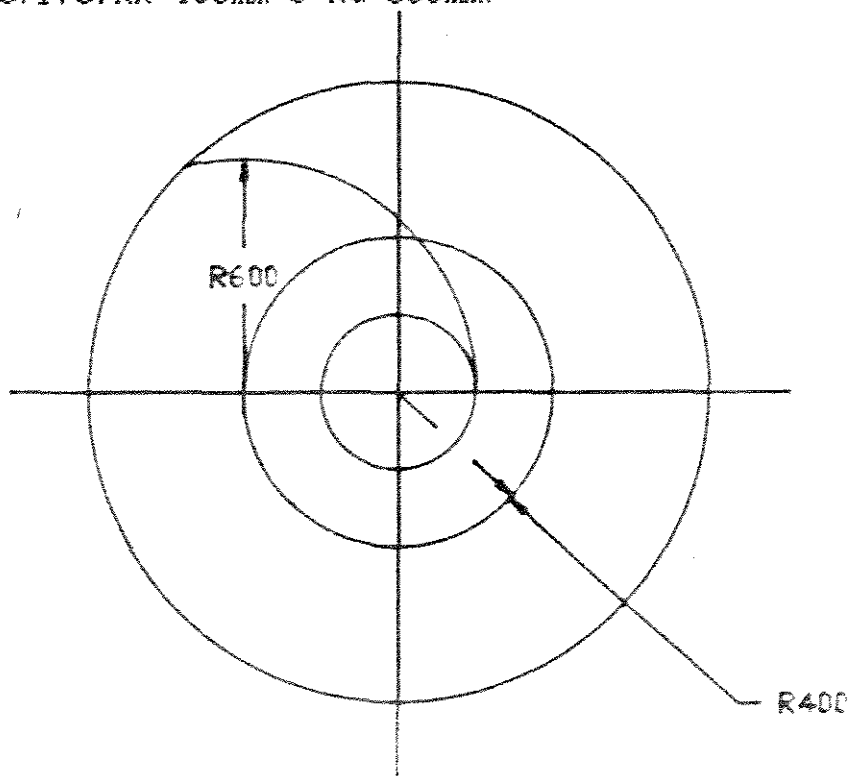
RR=400mm e RC=500mm.
